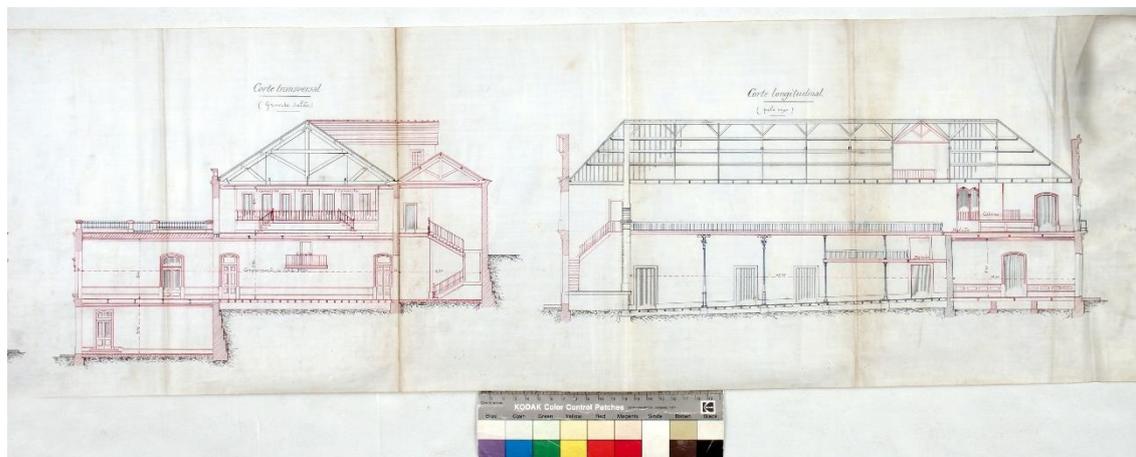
Corte transversal com vista sobre os salões voltados para o Jardim, caixa de escadas e loja; corte longitudinal da sala de espetáculos
